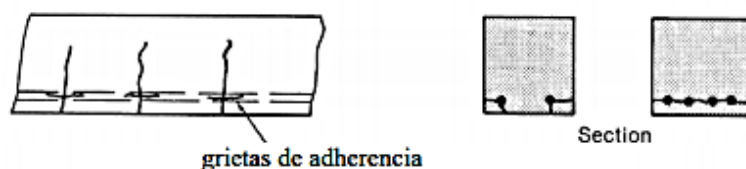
Grietas de adherencia entre el concreto y el acero
